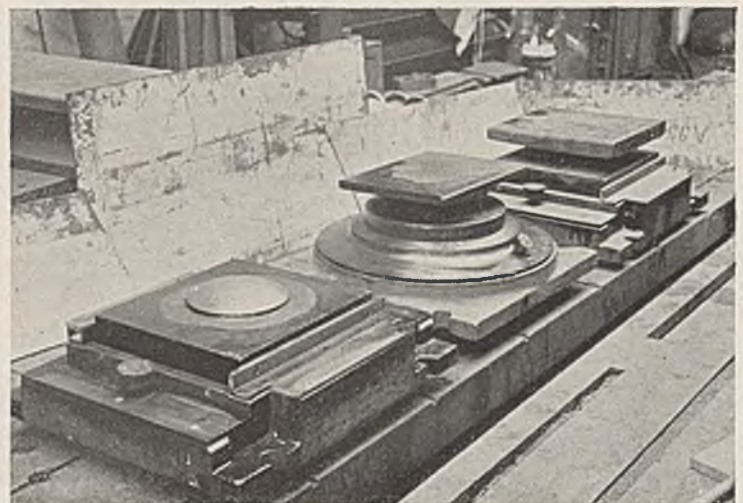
Äußeres der geschlossenen Lager. Links und rechts das längsbewegliche Hauptlager, in der Mitte das allseitig bewegliche Zwischenlager.
